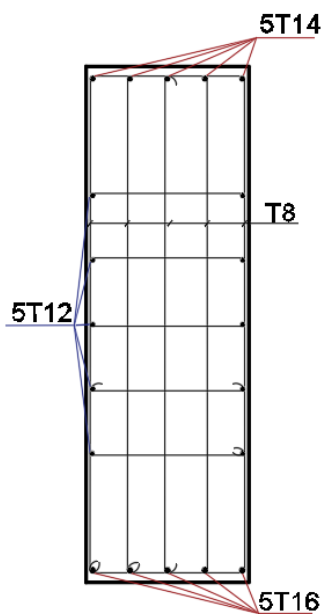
Schéma de ferrailage des nervures sur appuis.
